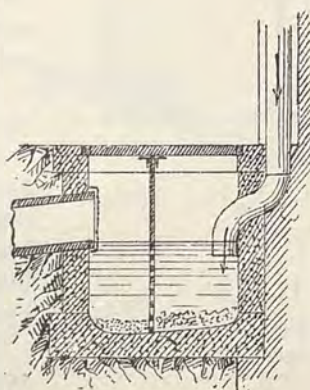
Pozzetto al piede dei tubi pluviali.
